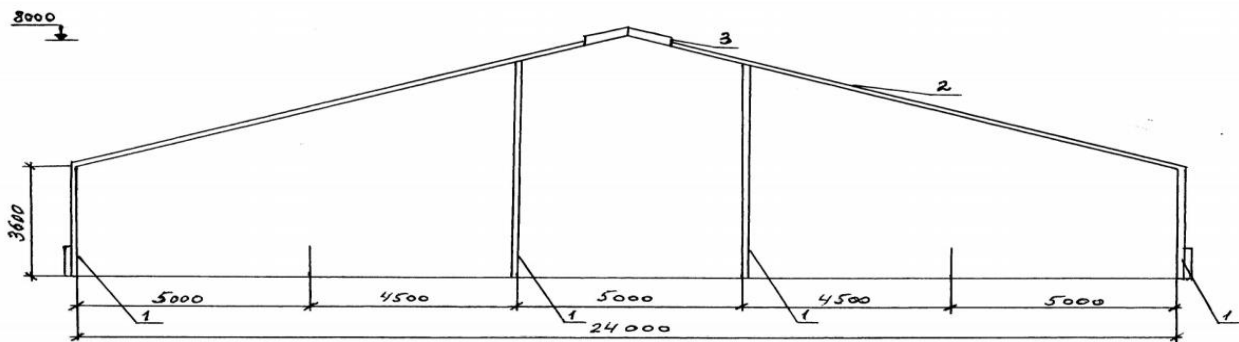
Схема поперечного розрізу новозбудованого приміщення: 1 – металева колона; 2 – металева балка; 3 – світлоаераційний гребінь.
